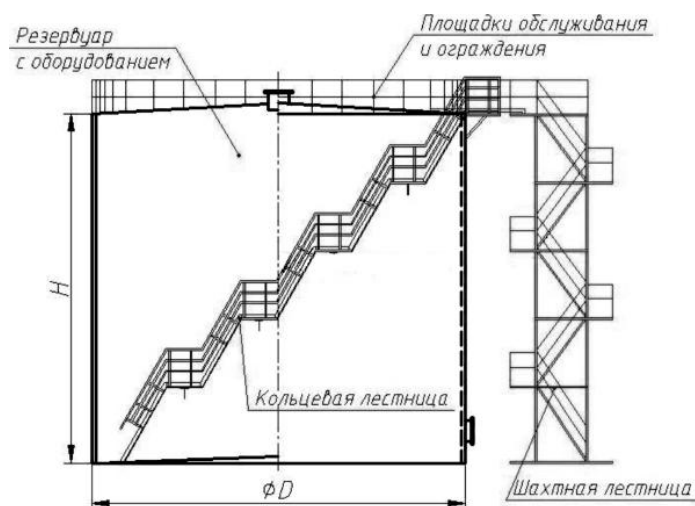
Схема кольцевой и шахтной лестниц [33]
